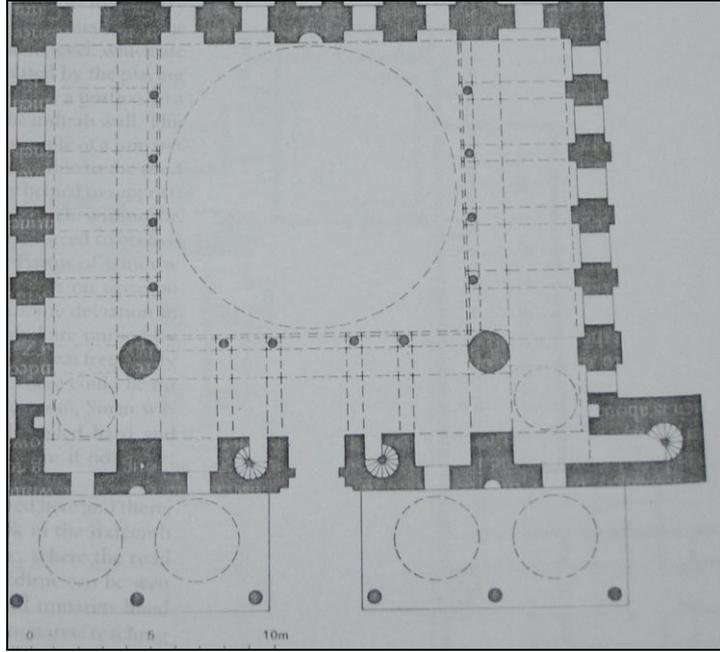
المسقط الأفقي لمسجد رستم باشا - استانبول
